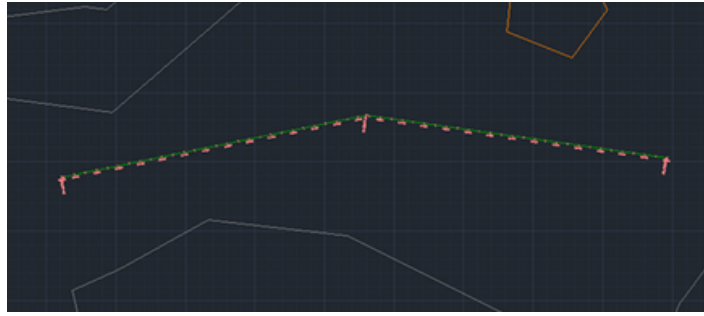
Alineamiento horizontal plasmado en el plano
